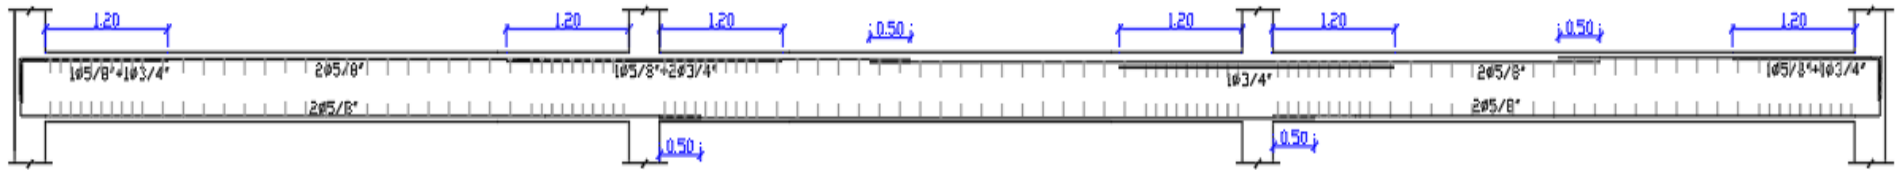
Vista elevación del detalle de refuerzo de la viga V-T015 en el 3° nivel.
